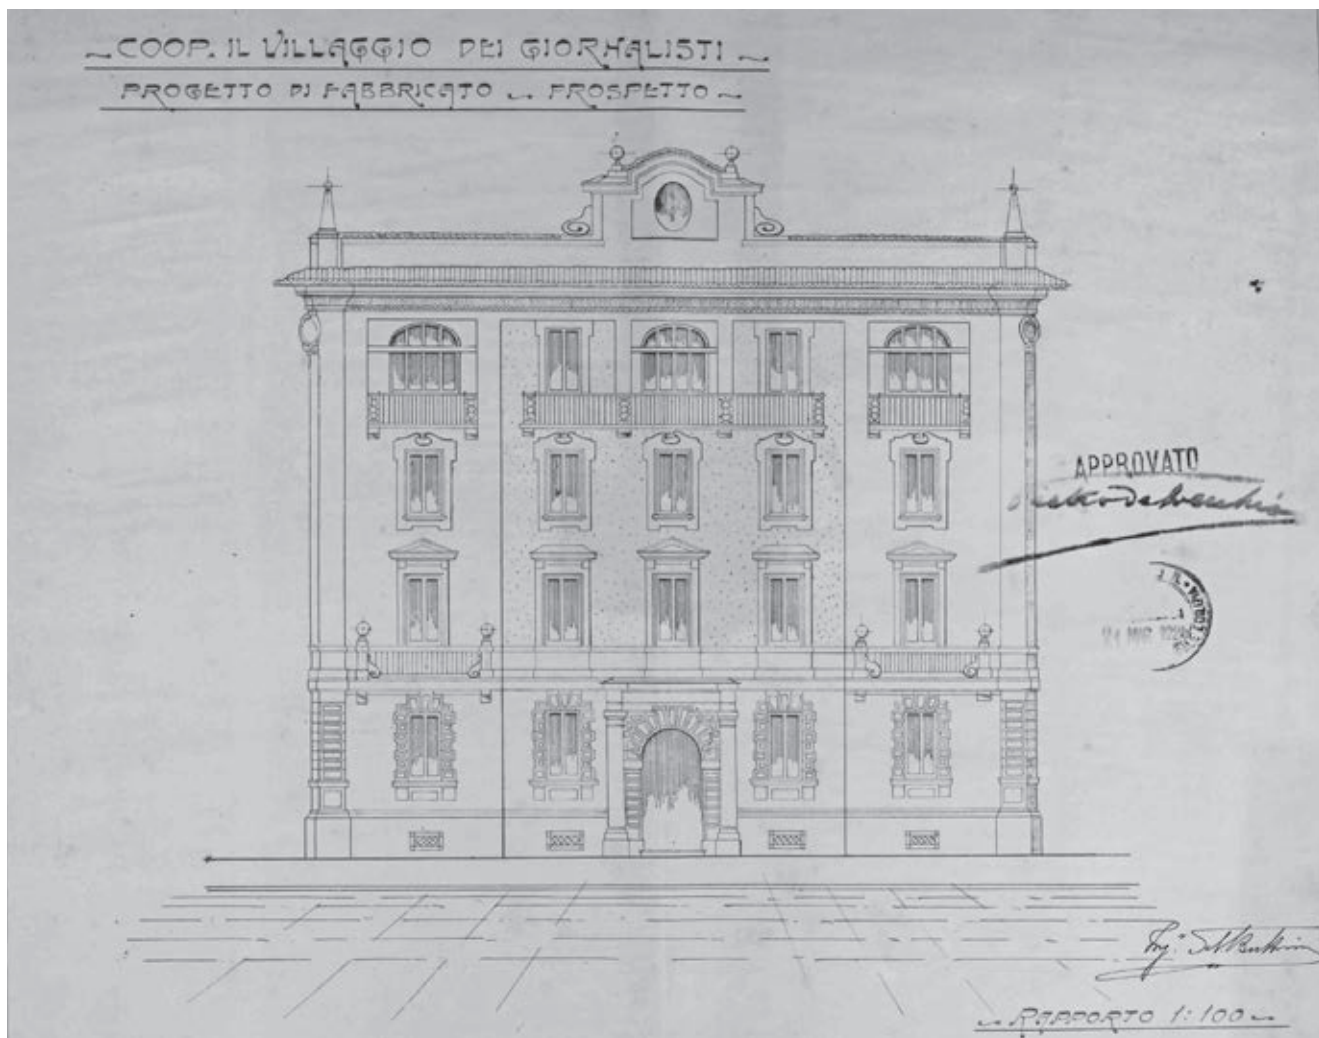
Sebastiano Bultrini, Roma. Progetto per edificio in via L. Spallanzani per la Coop. Villaggio dei Giornalisti. Prospetto principale, scala 1:100 (ASC, Ispettorato Edilizio, prot. 9361/1924).
